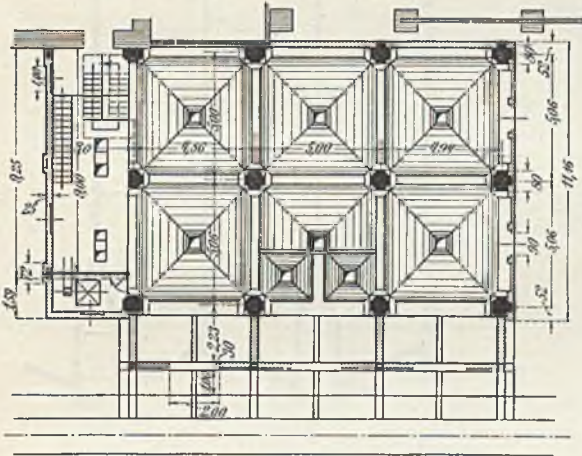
Zementsilo Thayngen. Erdgeschoß, Grundriß.
